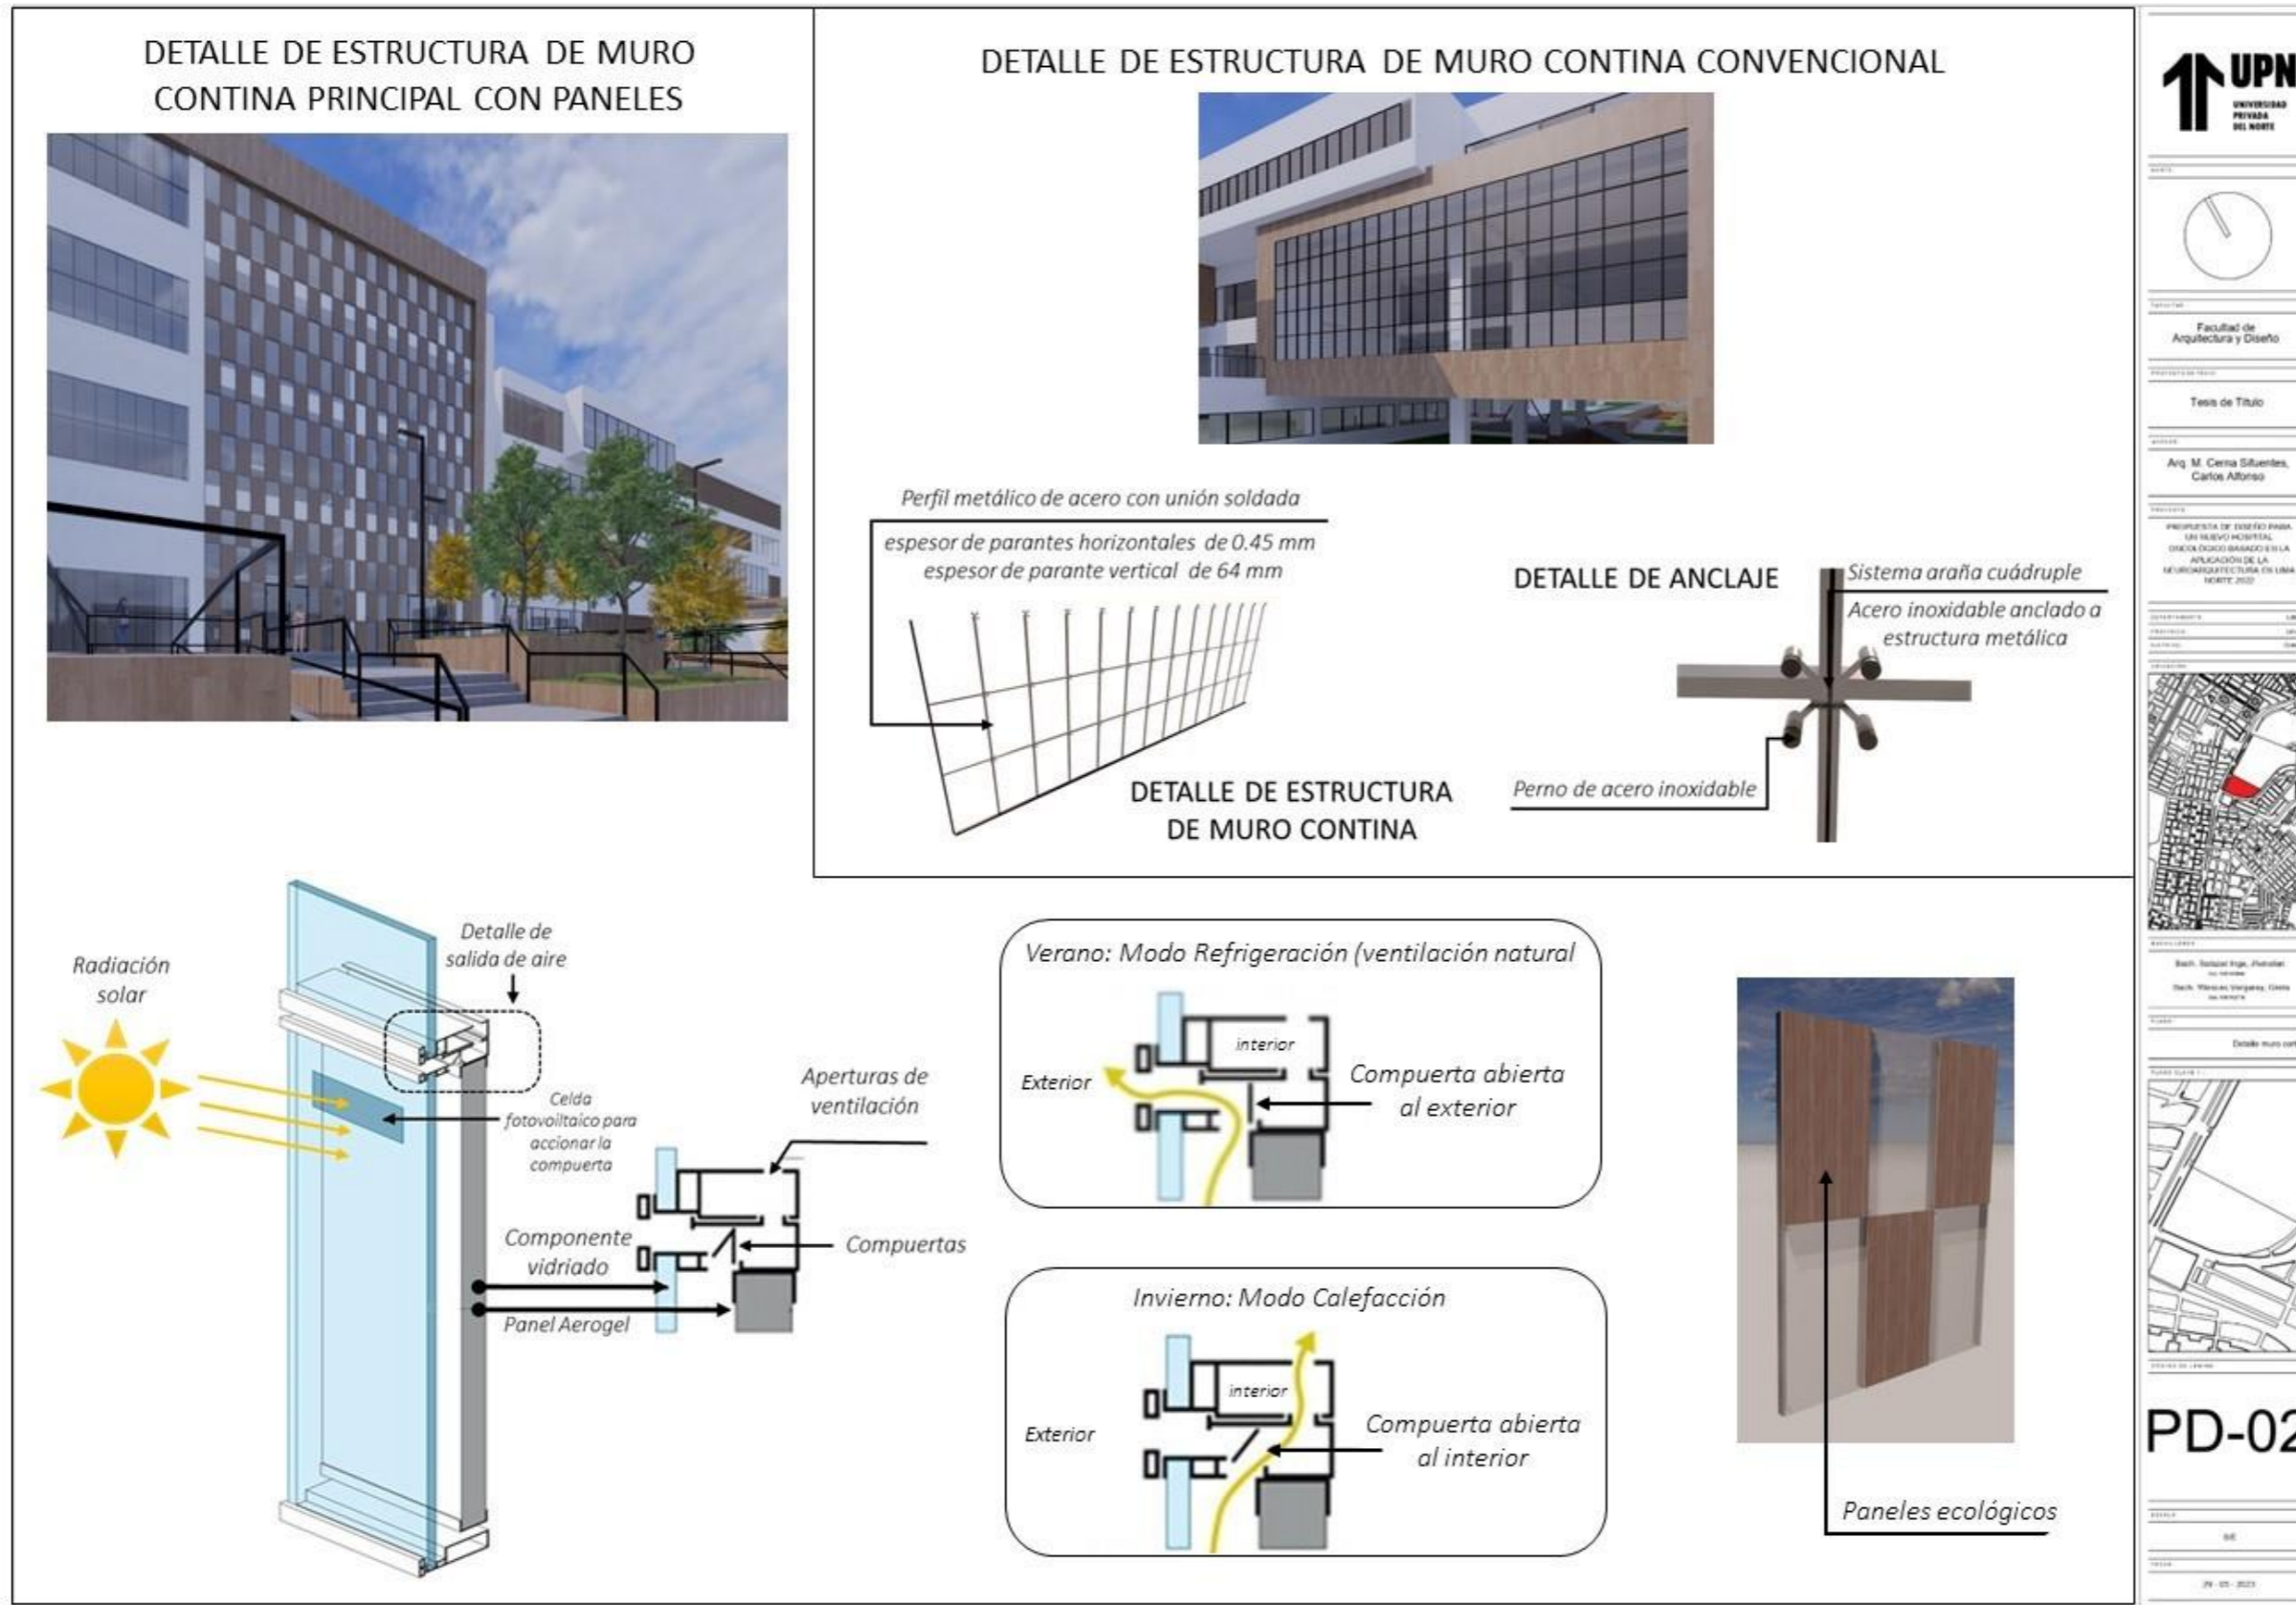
Arquitectura – Lamina de detalles Arquitectónico en 3D N° 1 Esc: 1/75 (Fuente: Elaboración propia de los coautores)
